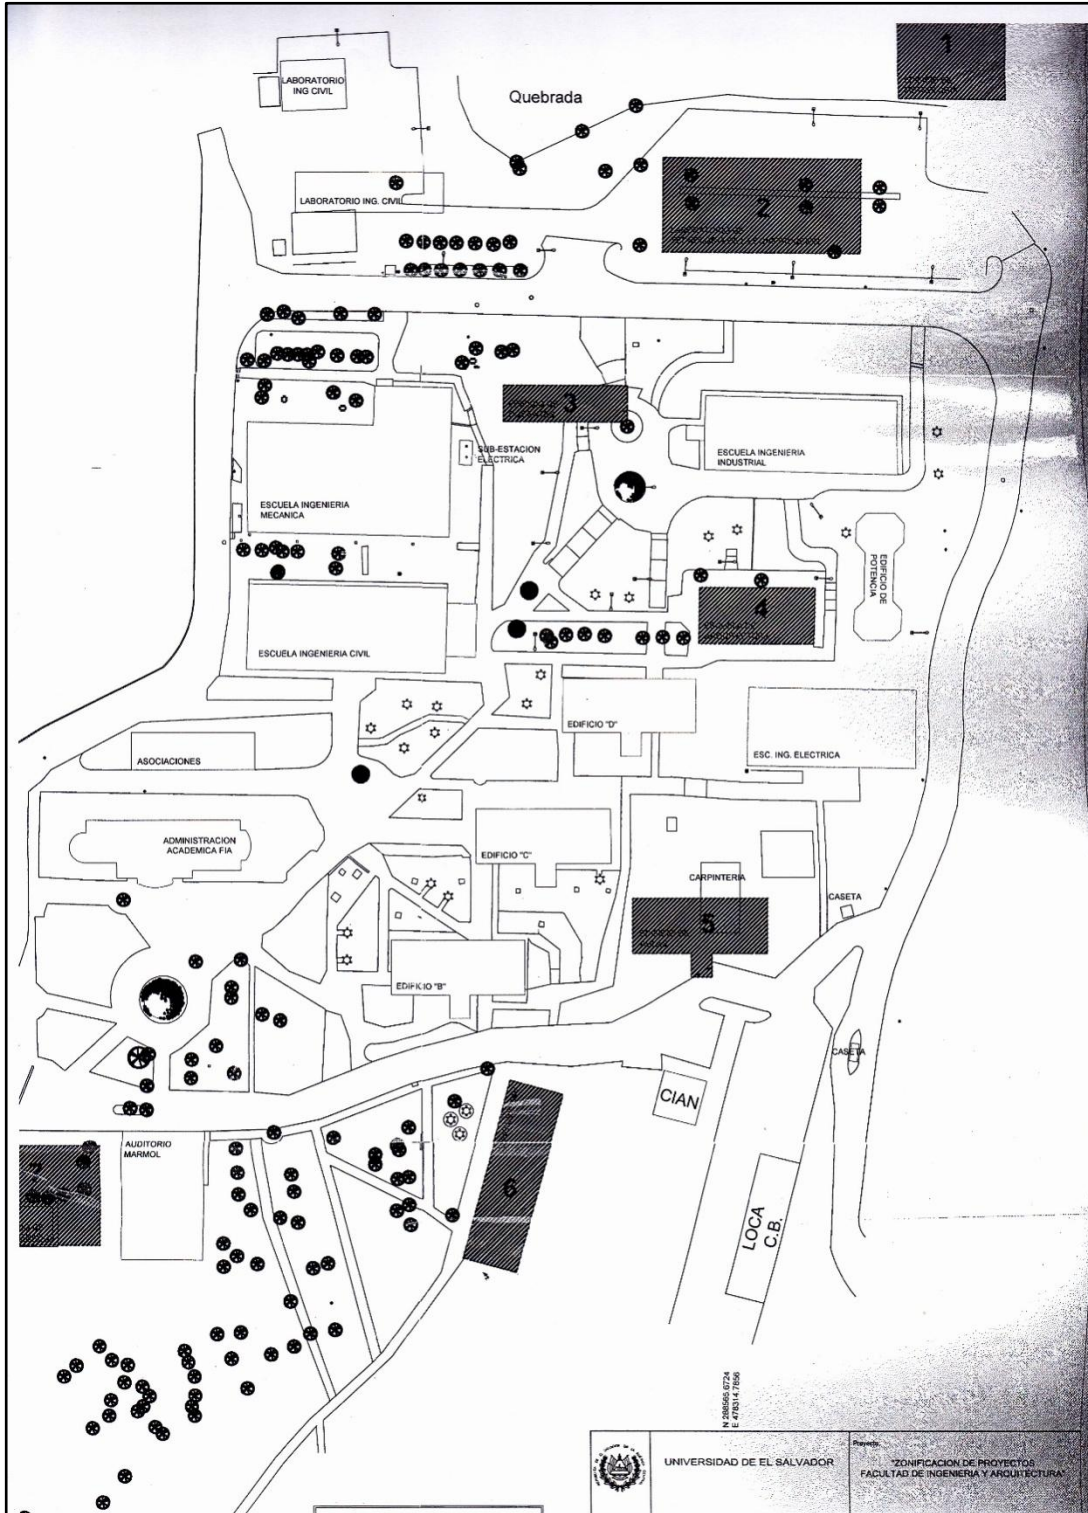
Planos de la Facultad de Ingeniería y Arquitectura
